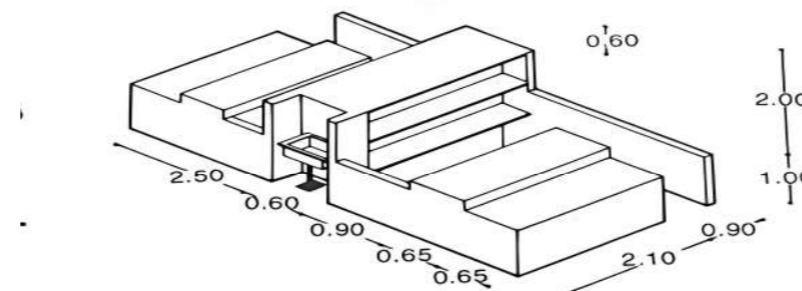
Alzado y dimensiones de un puesto tipo.
